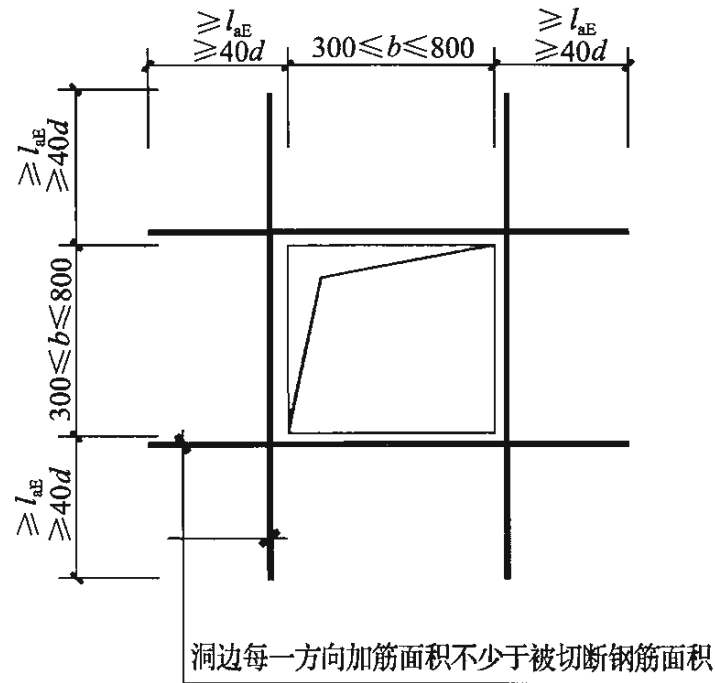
剪力墙一般小洞口的加筋示意
